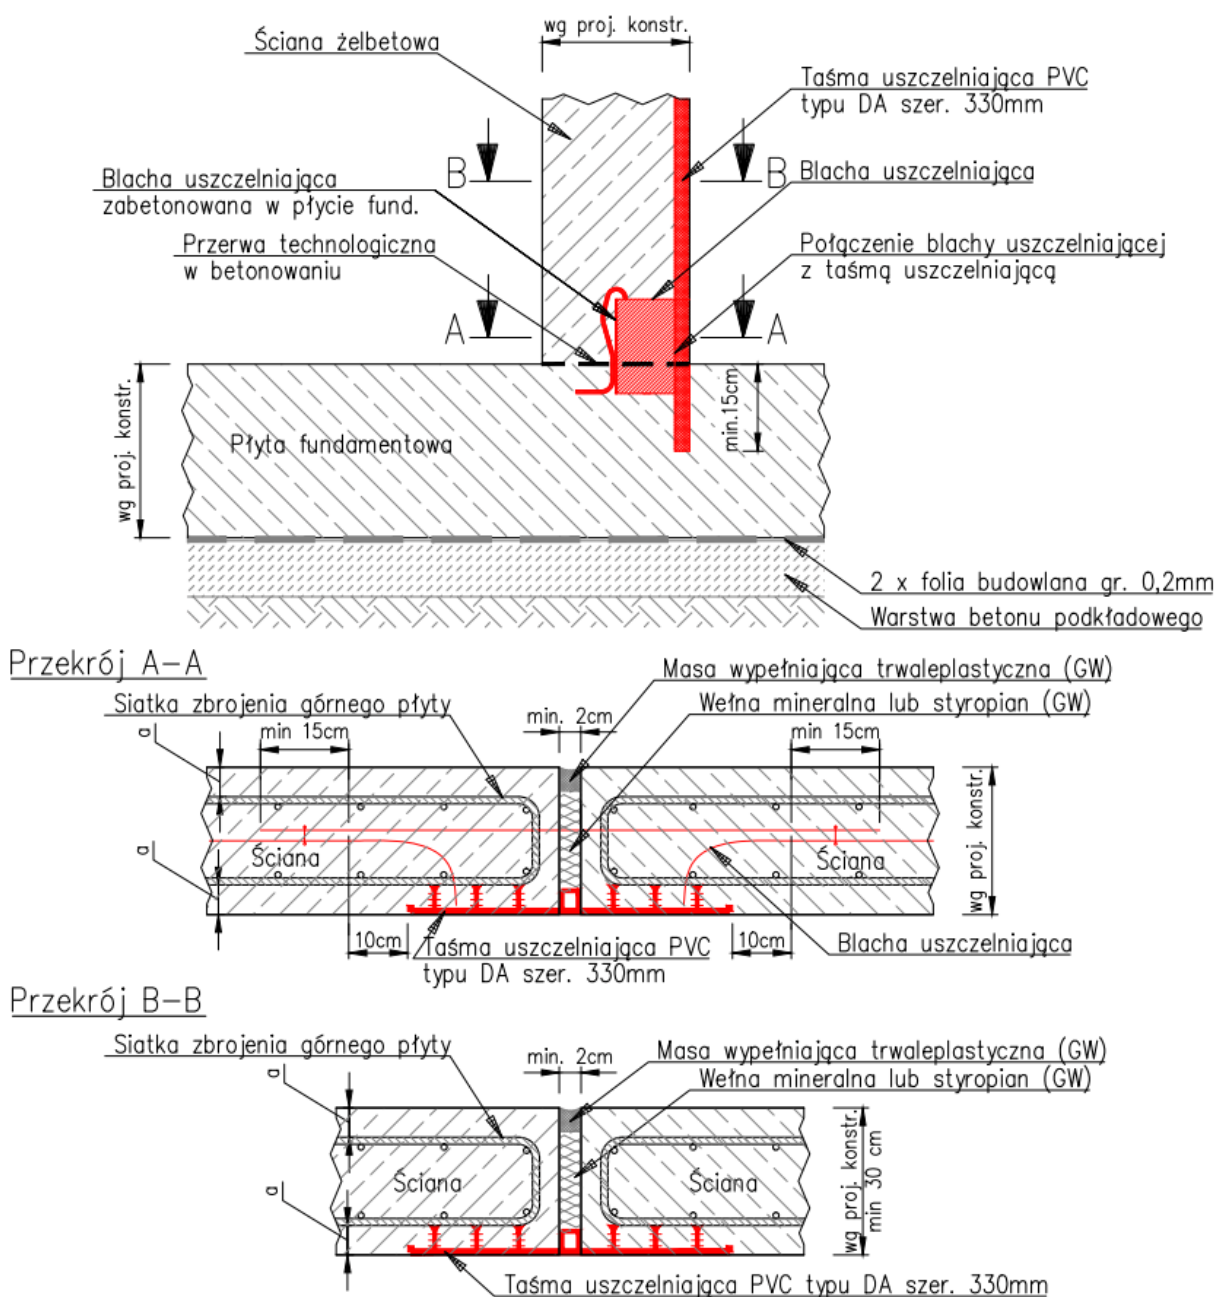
Schemat uszczelnienia przerwy technologicznej w betonowaniu:
